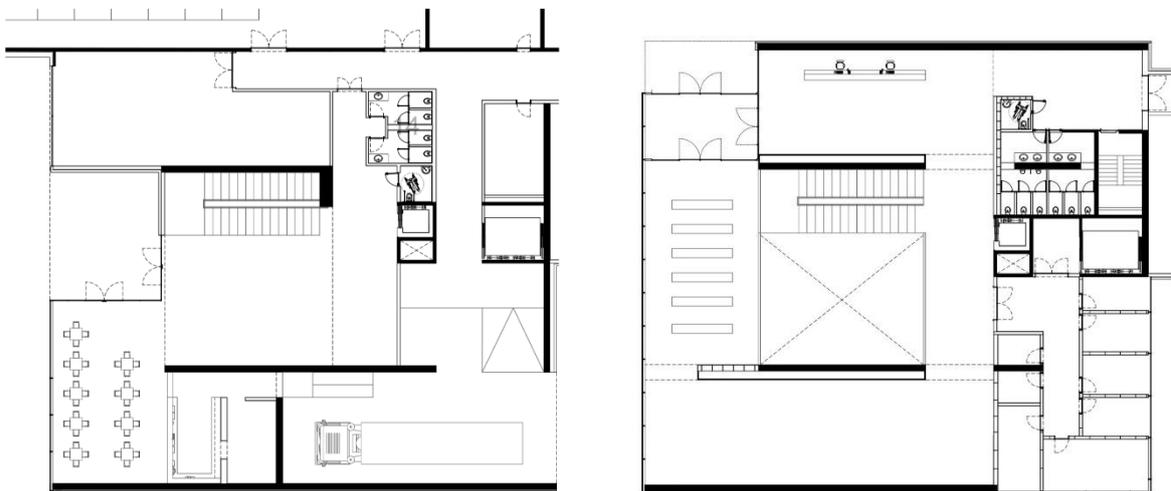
Plantas da estrutura: Piso 0 e Piso 1
